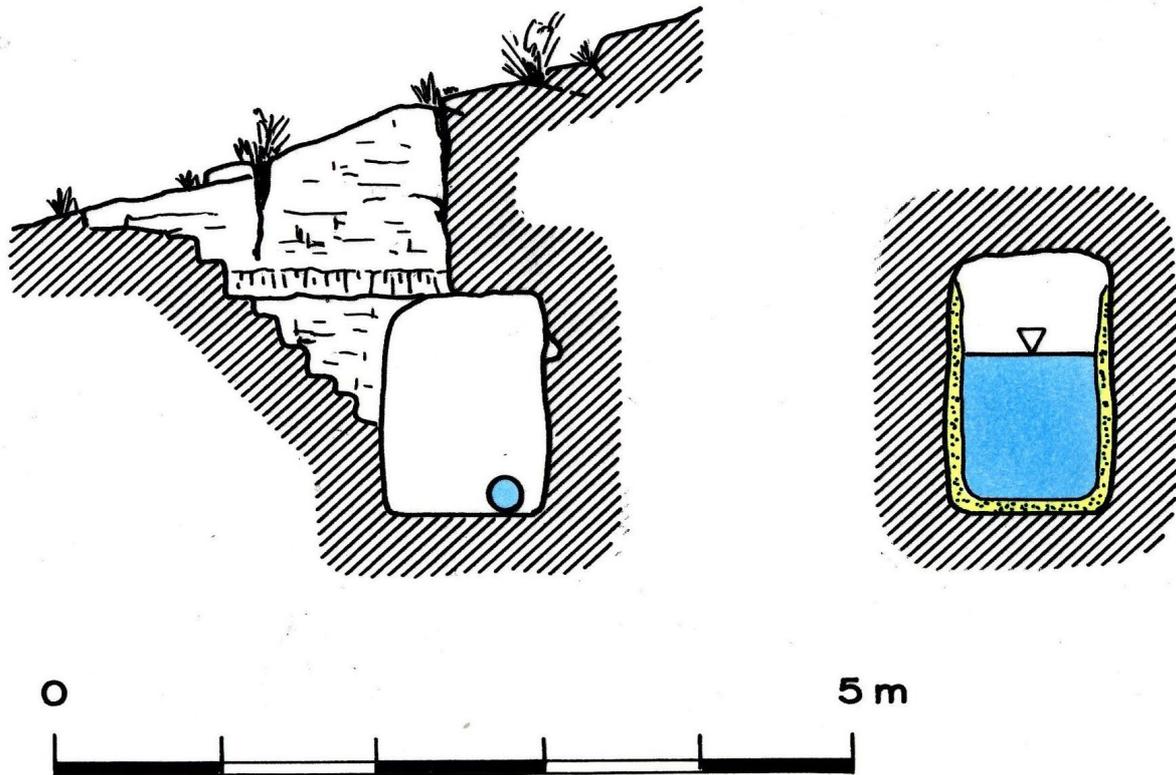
‚Qanat Turab‘: Links Tunnel mit Bauschacht, rechts nach der Einleitung des Wassers aus dem jüngeren ‚Qanat Fir‘aun‘.
